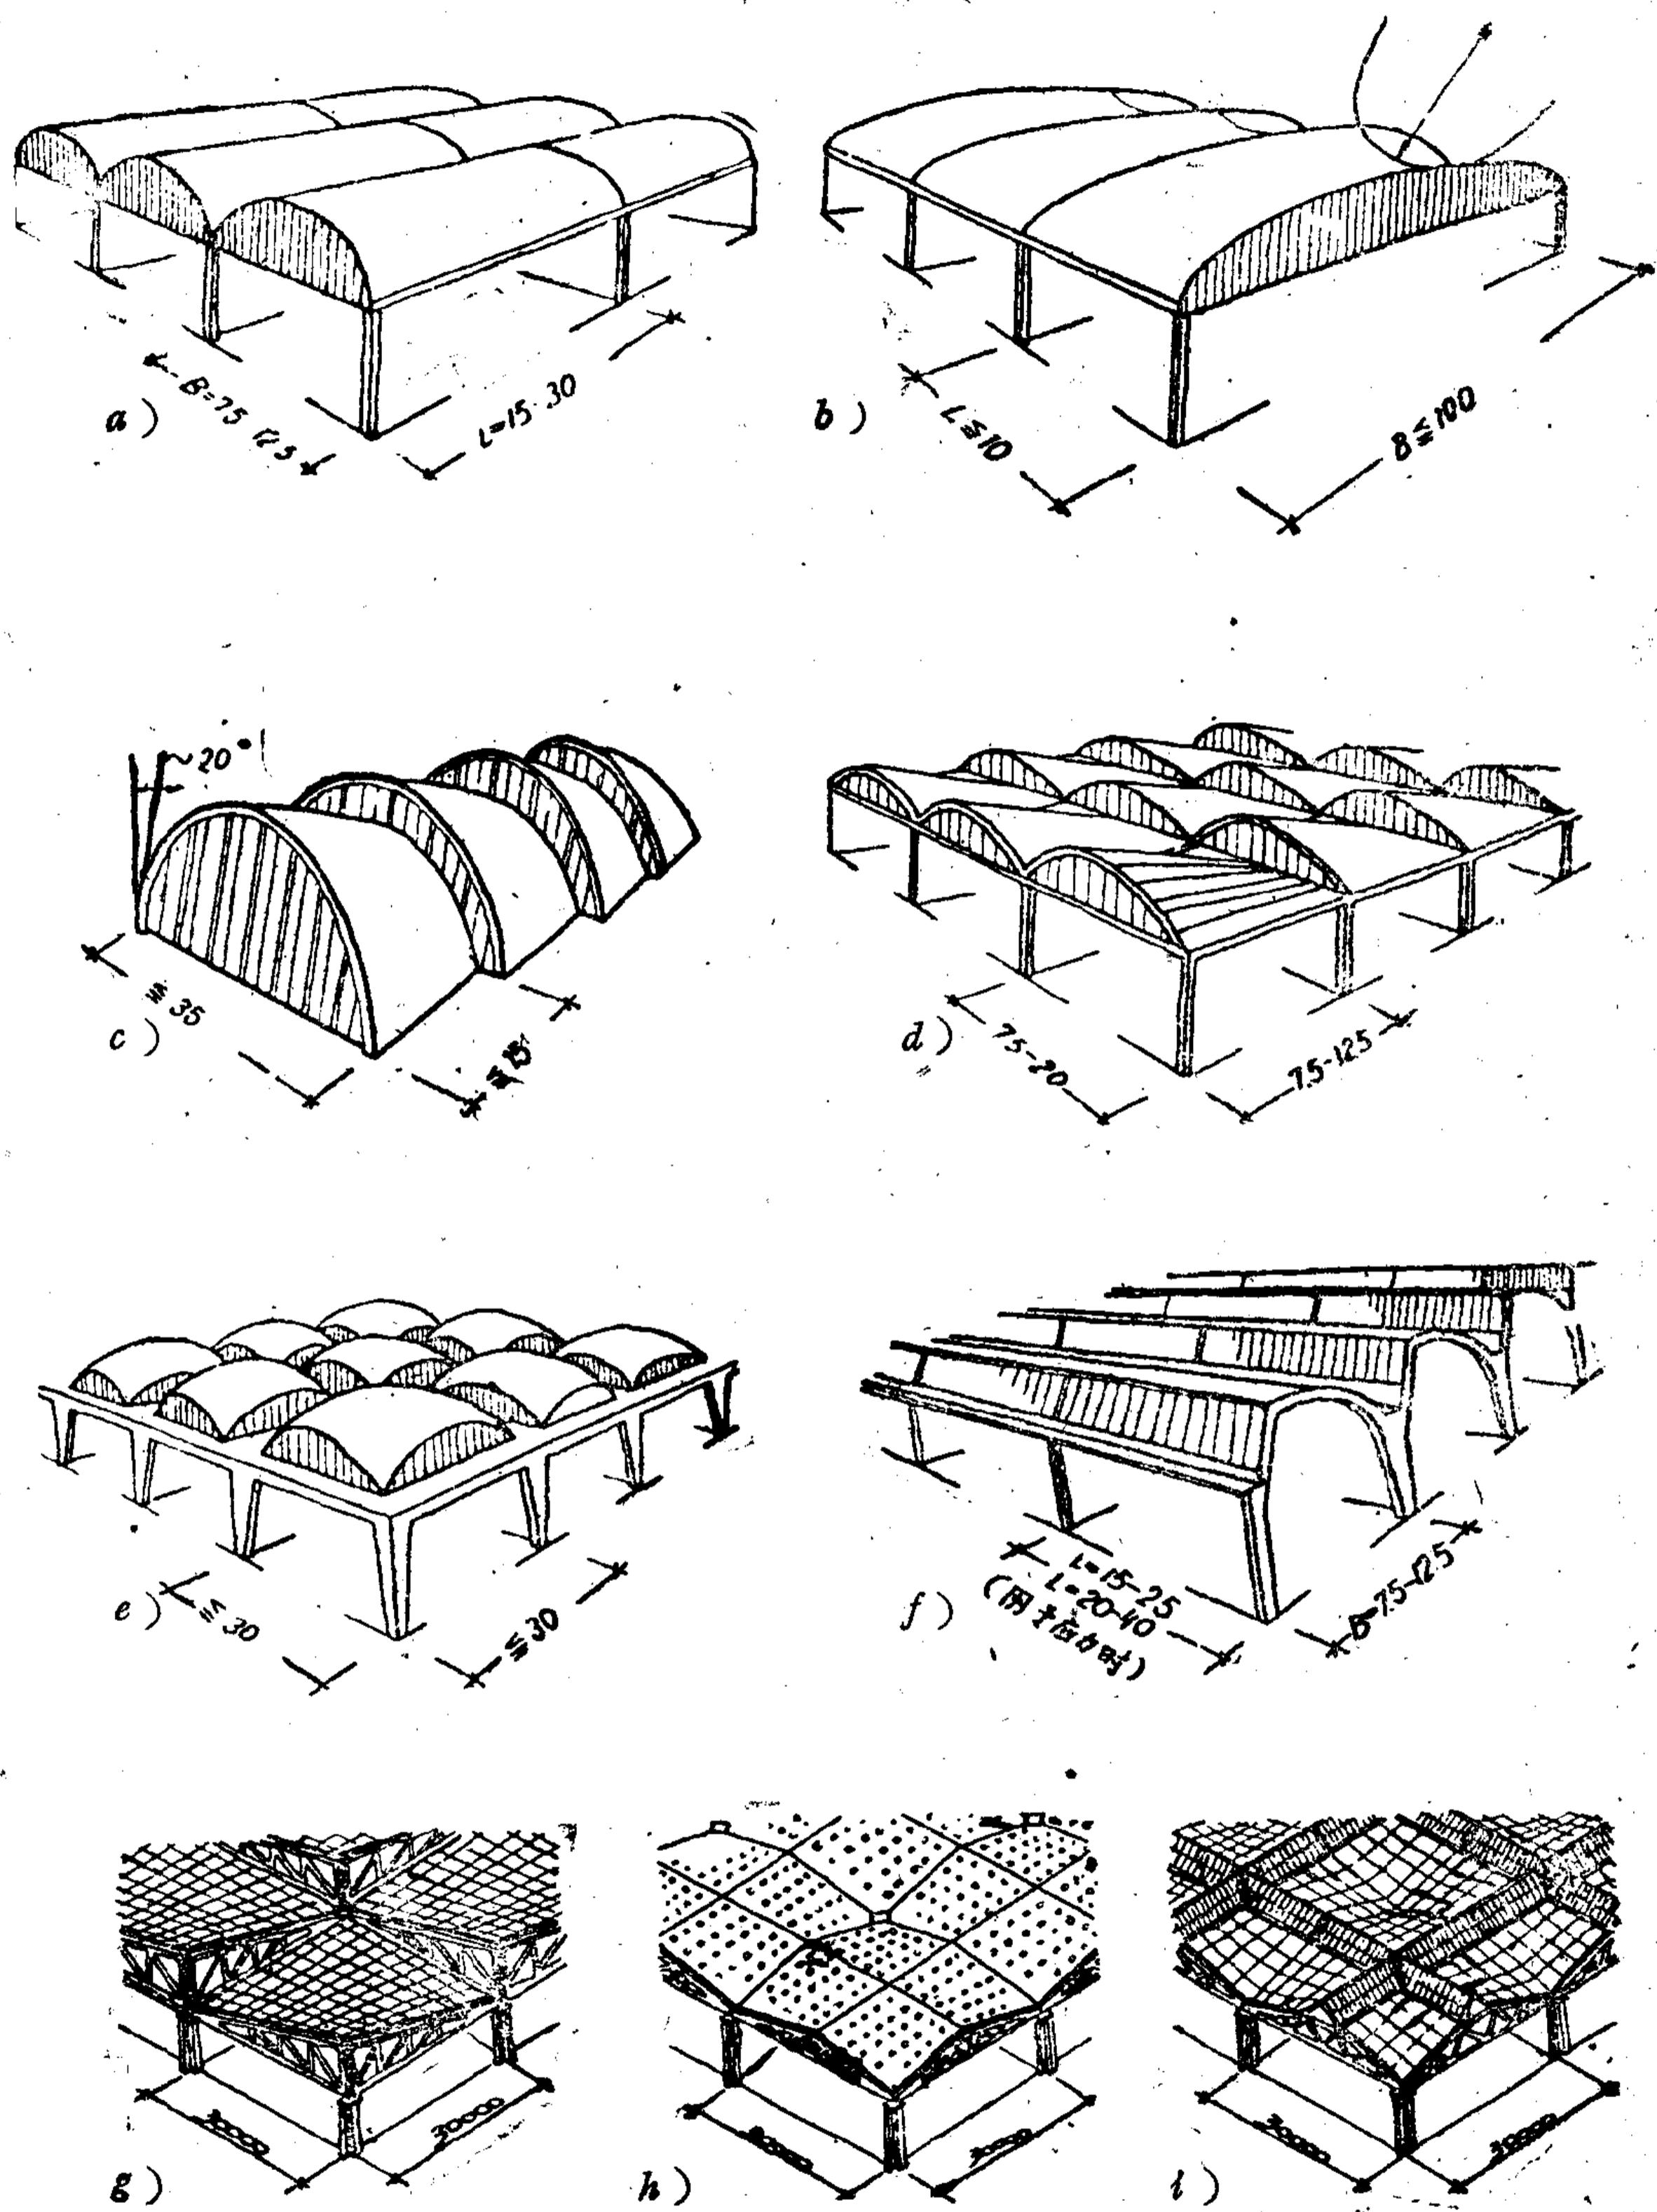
各种钢筋混凝土薄壳结构屋顶形式
